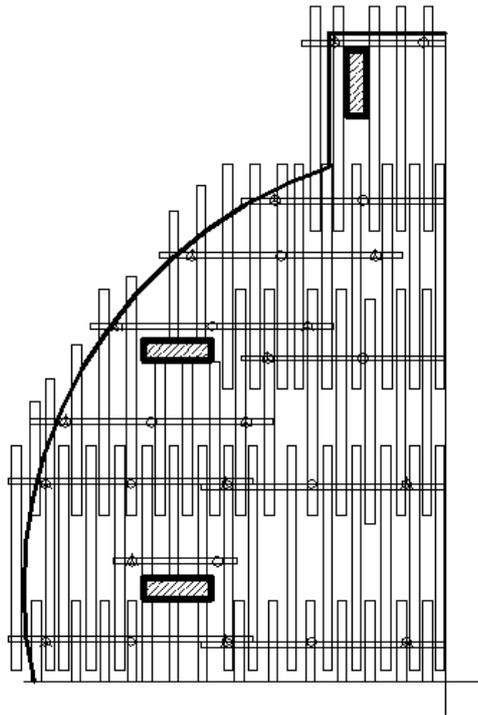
Фрагмент схемы расстановки стоек и раскладки балок опалубки
